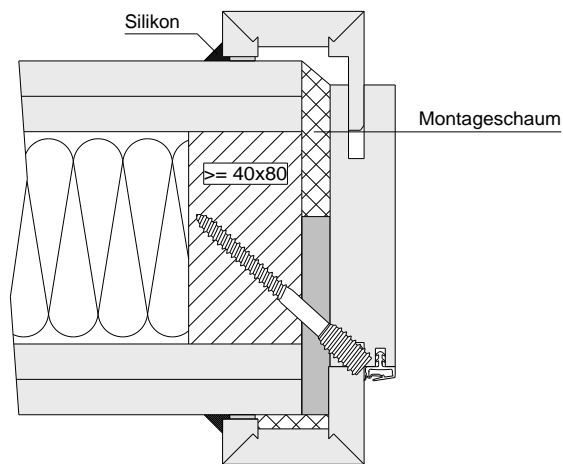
Holzzargenquerschnitt mit Befestigungsschraube
